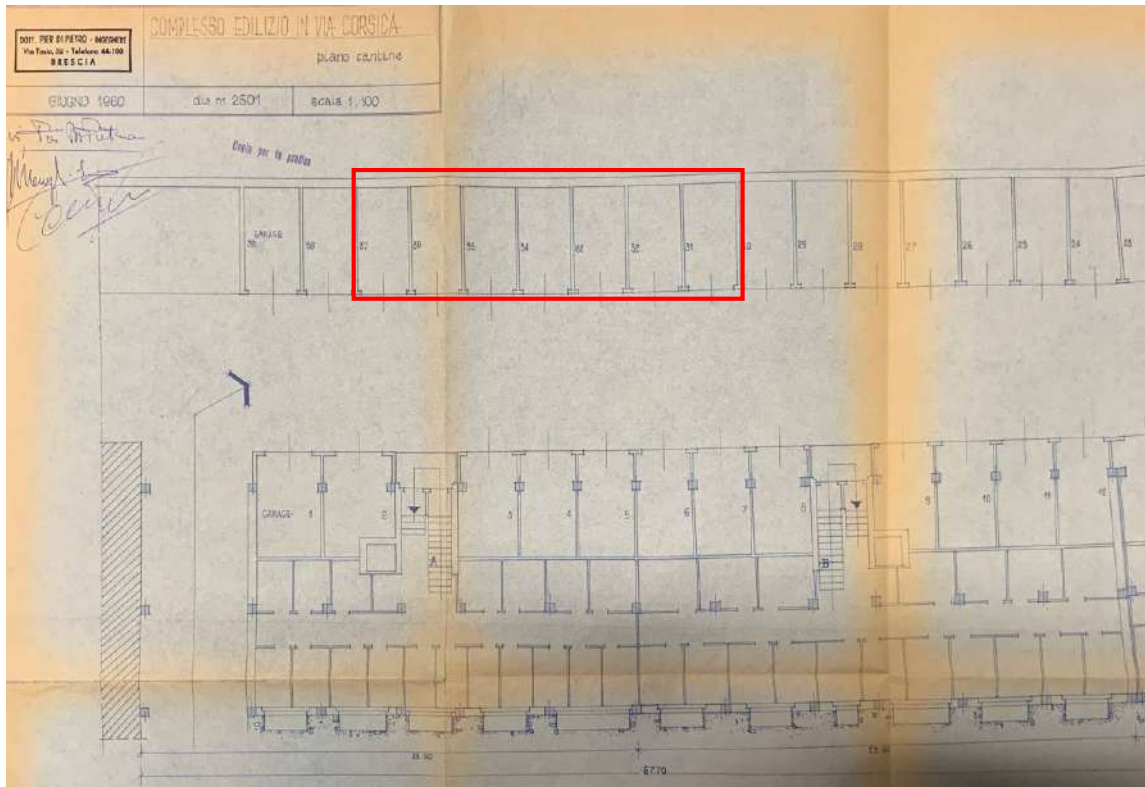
Estratto Dis. N.2501 allegato alla Autorizzazione Edilizia Prot. 3748 del 31.08.1960 - Pianta piano cantine
